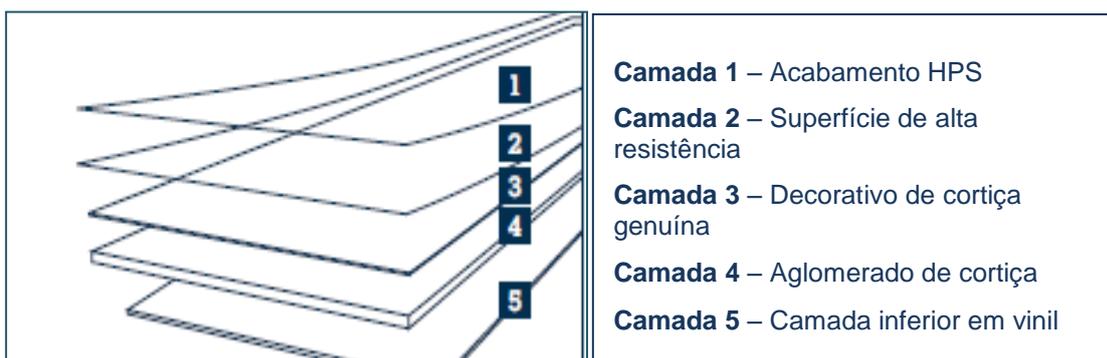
Constituição do Pavimento Colado com HPS [4]
